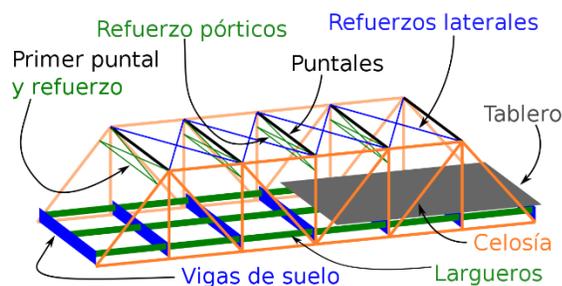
Partes estructurales del Puente Metálico (Industry, 1898)
